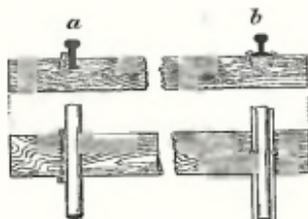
Schienenbefestigung auf hölzernen Schwellen.
